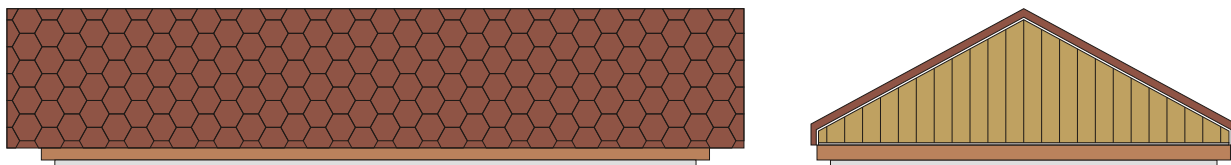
DACH W WARIANCIE „1” - DACH KOPERTOWY CZTEROSPADOWY (NAKLADKA NA STROPODACH), POKRYTY DACHÓWKĄ BTUMICZNĄ.
